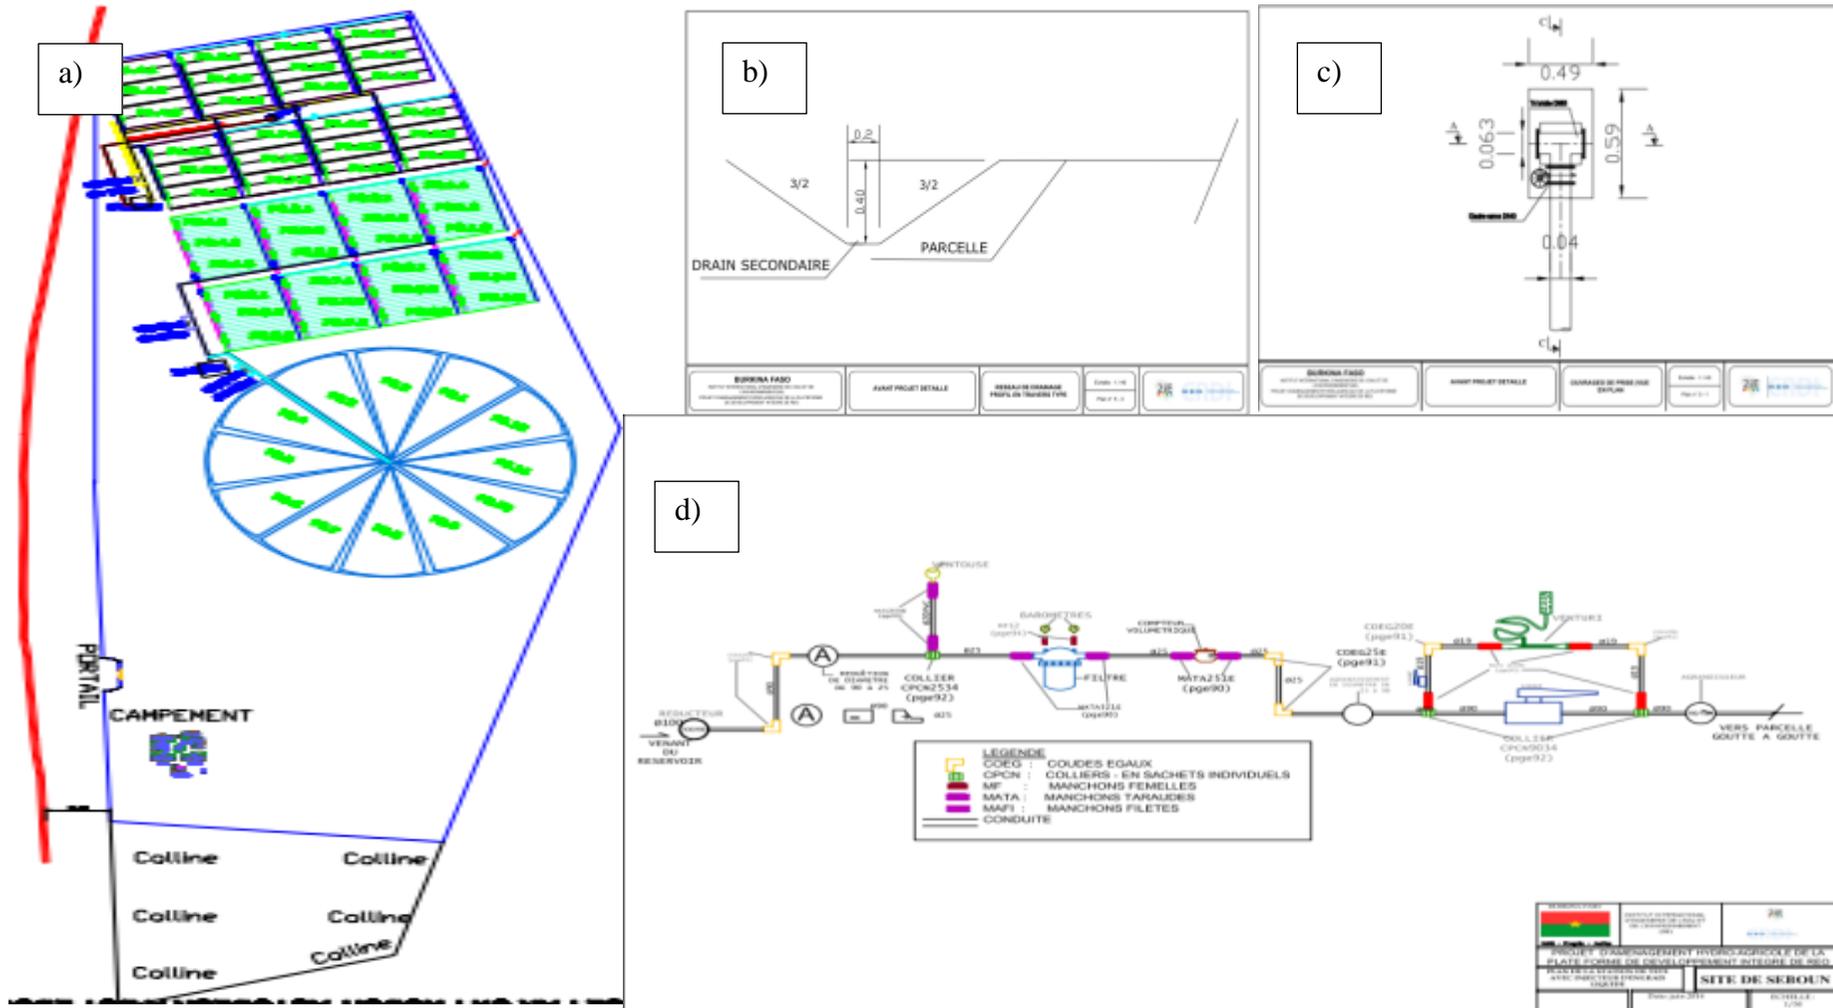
a) : plan d'aménagement du site b) drains secondaire c) prise en charge (vue en plan) d)station de tête
